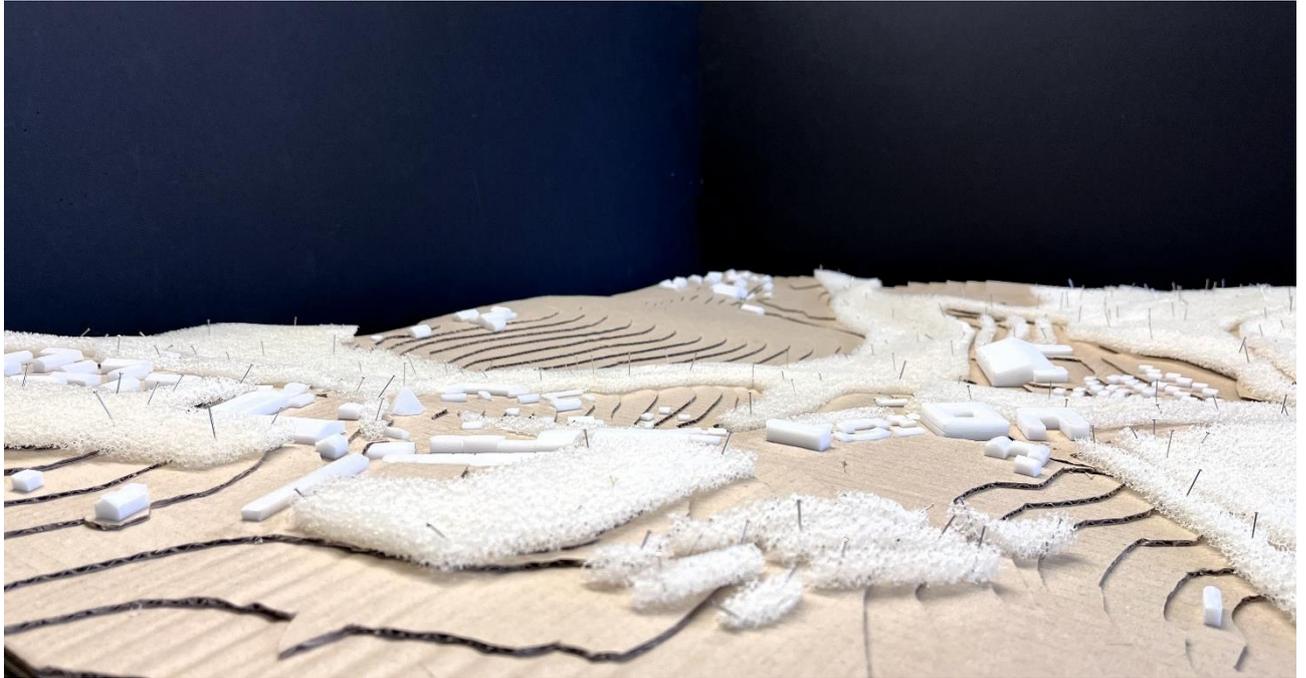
Modellfoto Geländemodell mit bestehender und geplanter Bebauung – Blick von Süd-Westen
